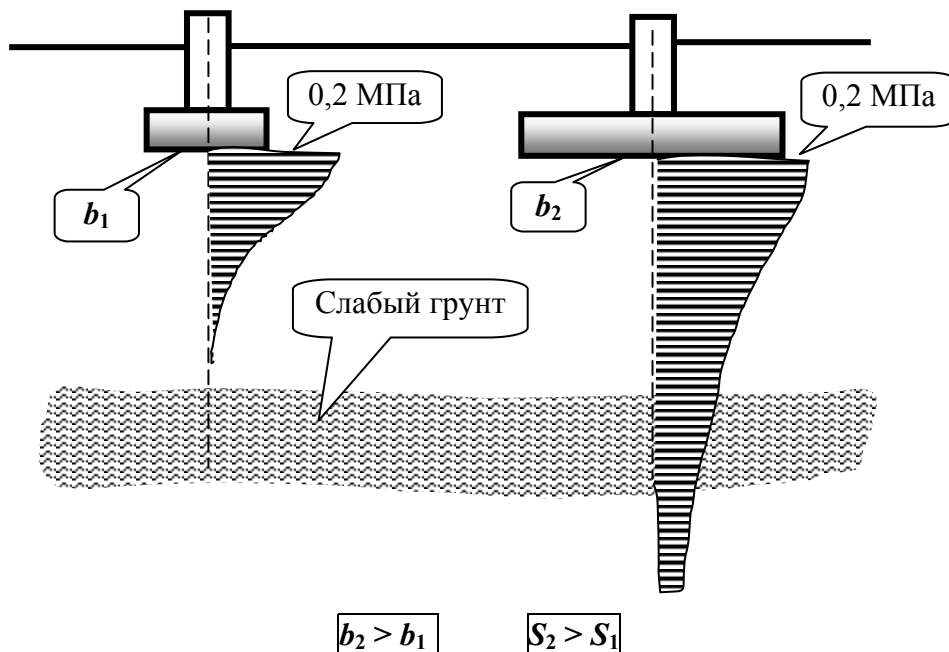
Неравномерные осадки уплотнения при неодинаковом нагружении фундаментов
